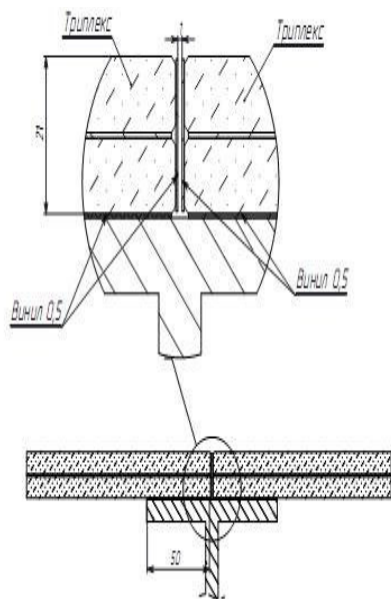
Примыкание стеклянных деталей пола друг к другу на жесткой балочной опоре
